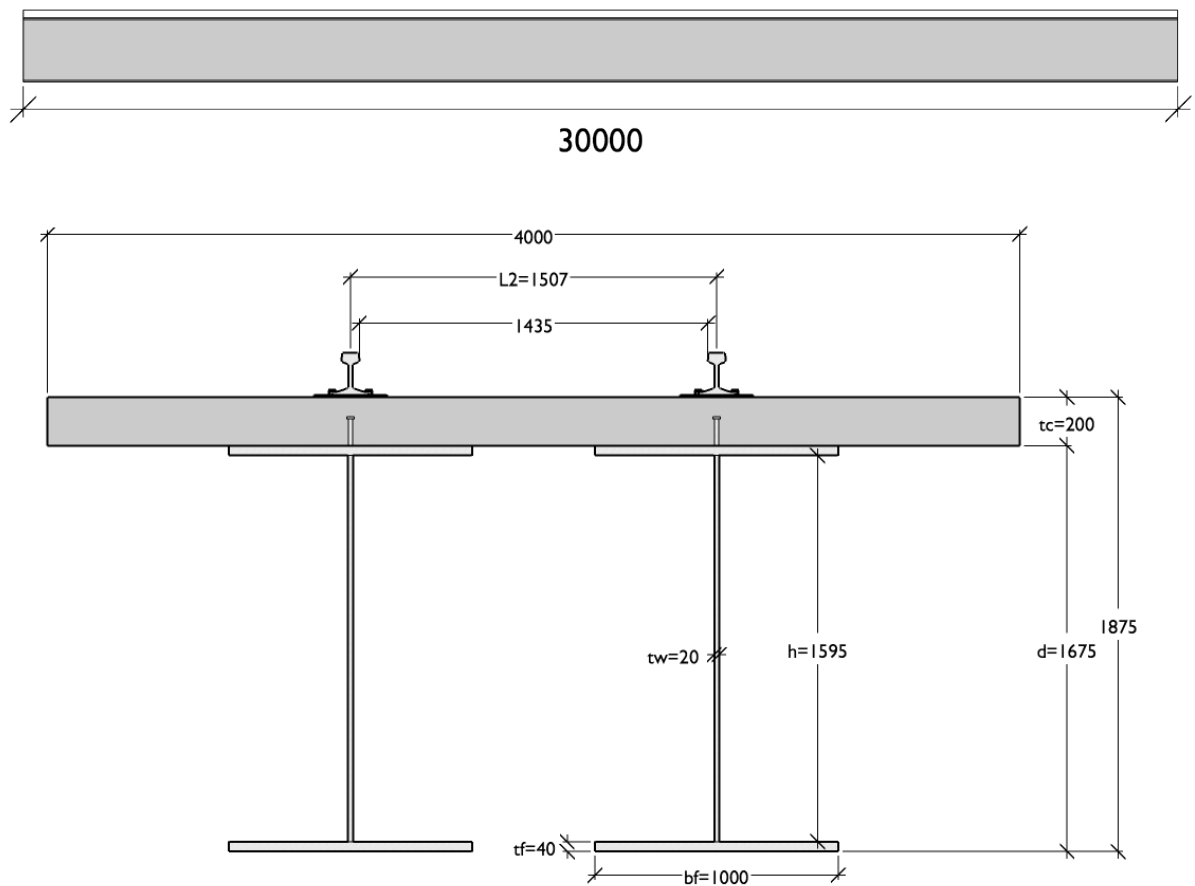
Geometria da viga mista adotada (medidas em milímetros)
